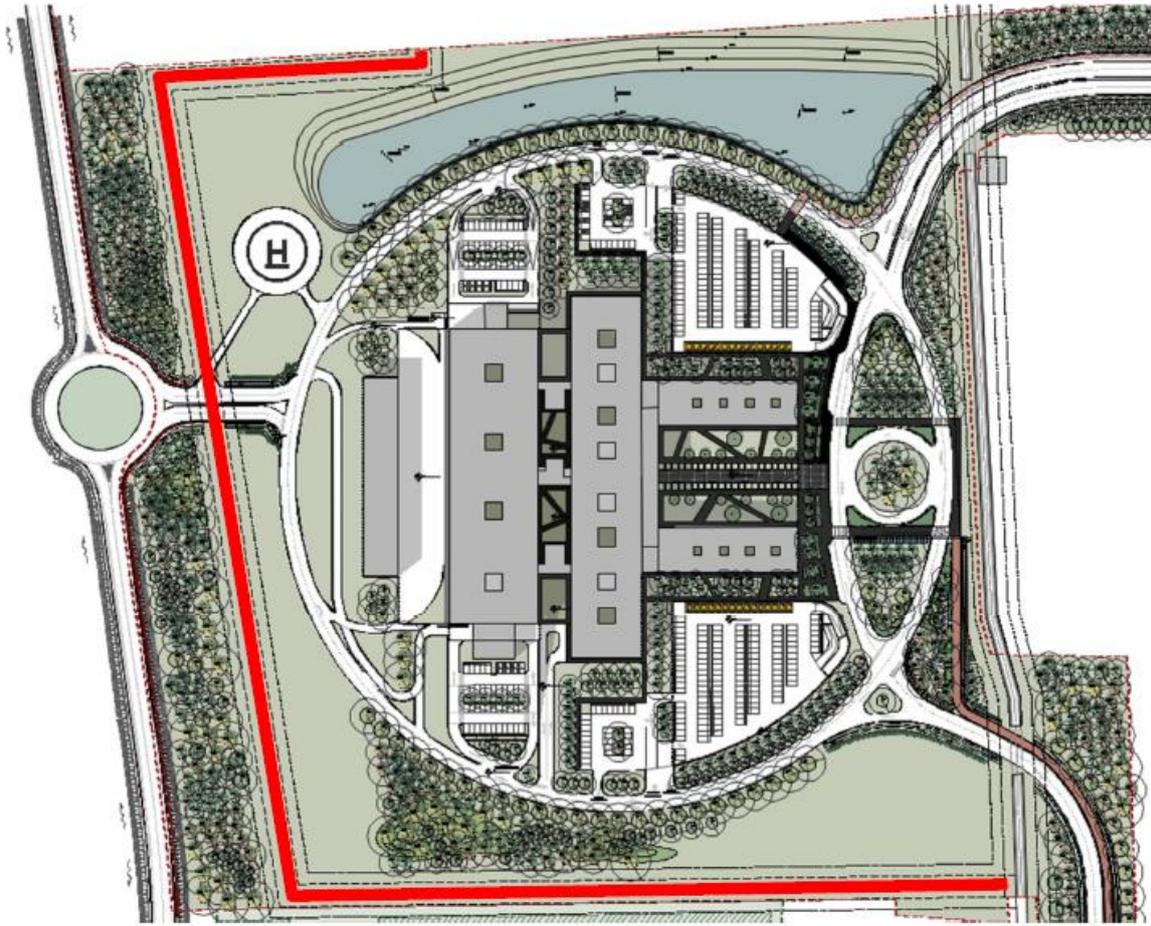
Planimetria schematica di progetto con deviazione del canale irriguo Carpigiano Alto
